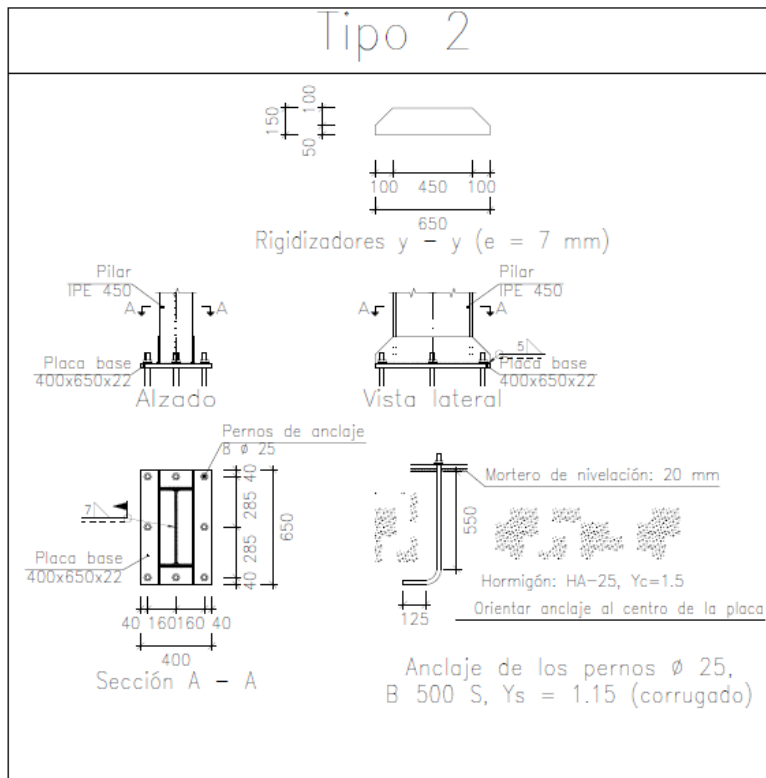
Detalle placa de anclaje tipo 2. Fuente: Elaboración propia a partir de CYPE 3D
